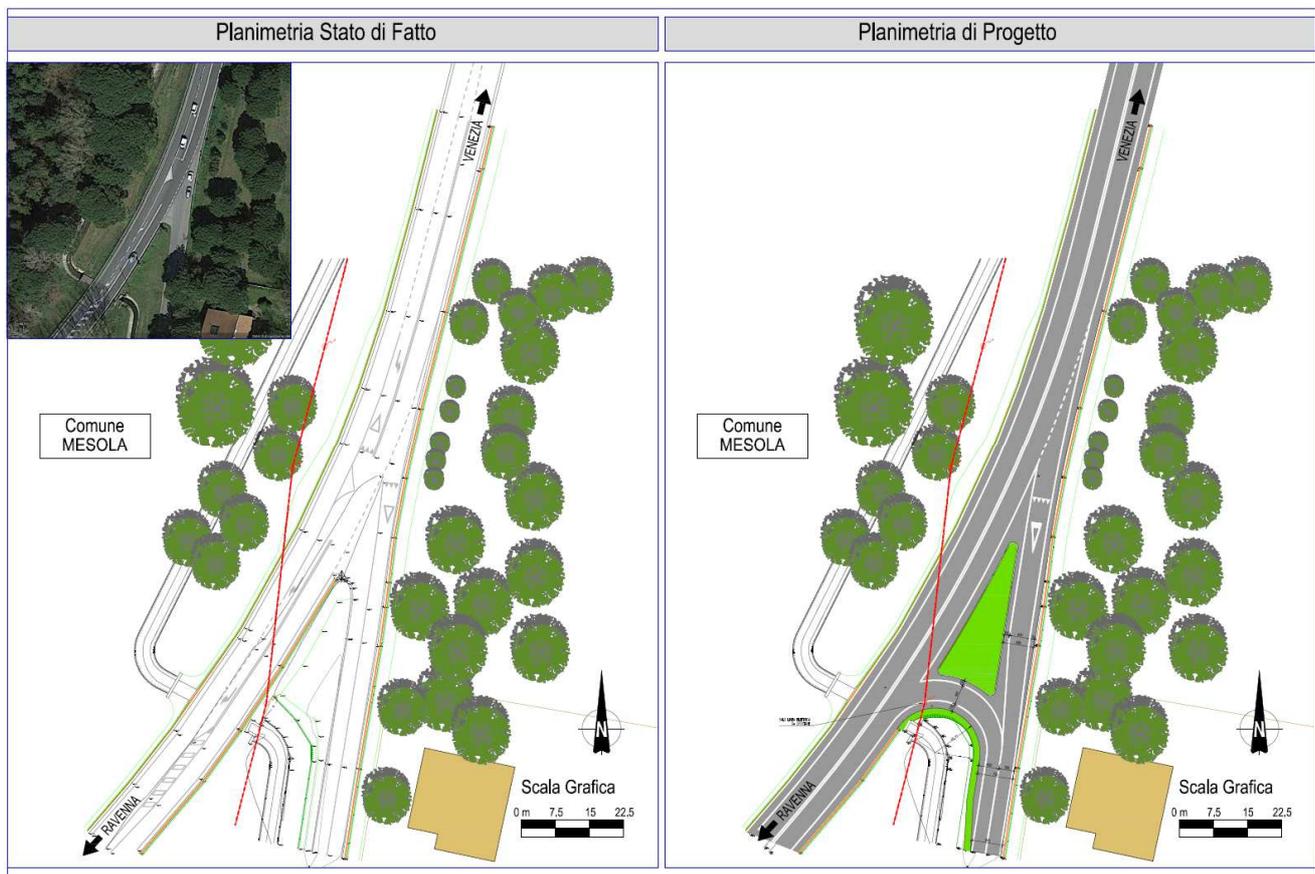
Intervento n° 21 – Planimetria Stato di fatto - Progetto
